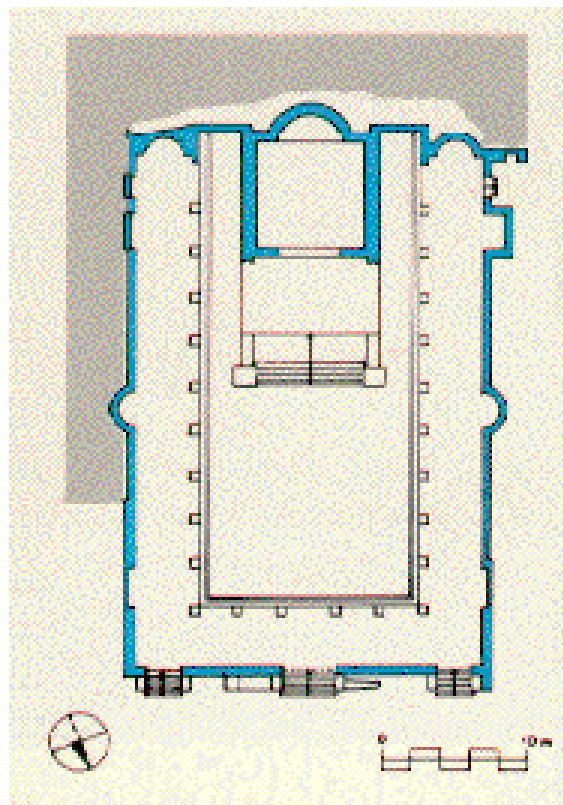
Tempio con Portico. Pianta (da Bertoldi 1973)
